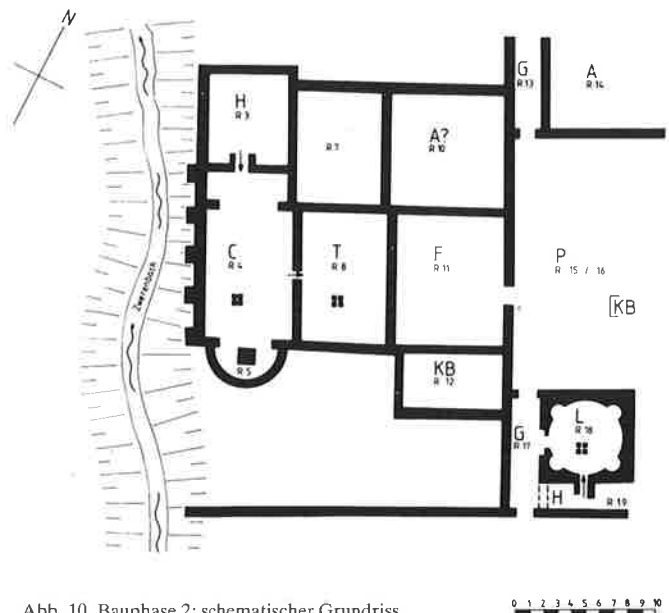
Bauphase 2; schematischer Grundriss
